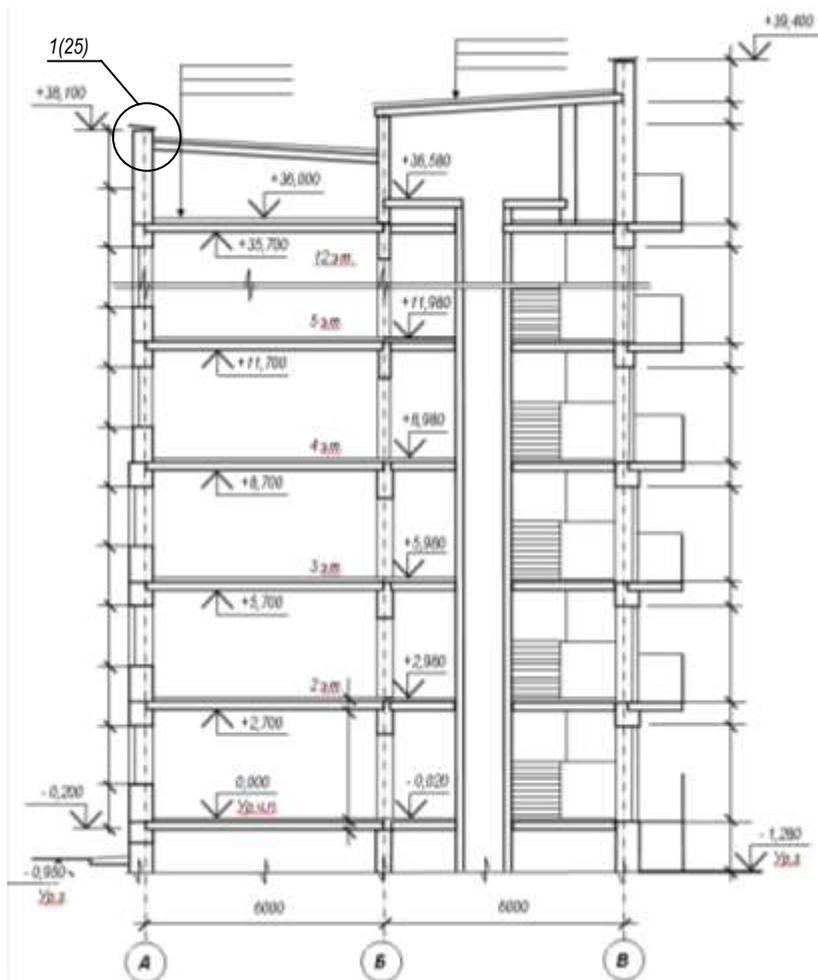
Пример оформления разреза жилого дома со стенами из кирпича или крупных блоков
